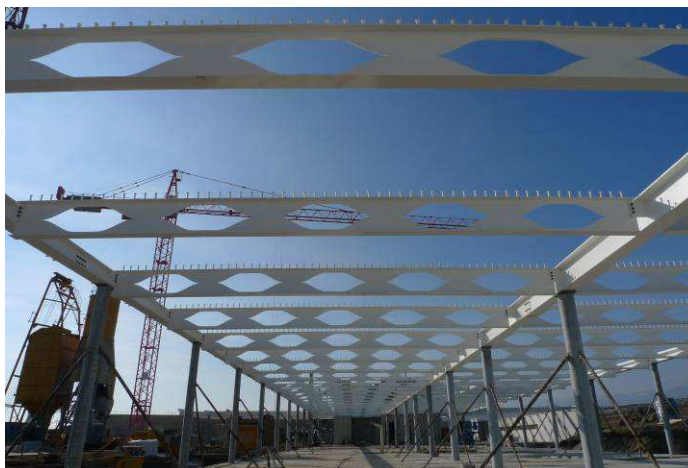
Nuevo tipo de viga – Angelina™ (viga mixta), durante el montaje
